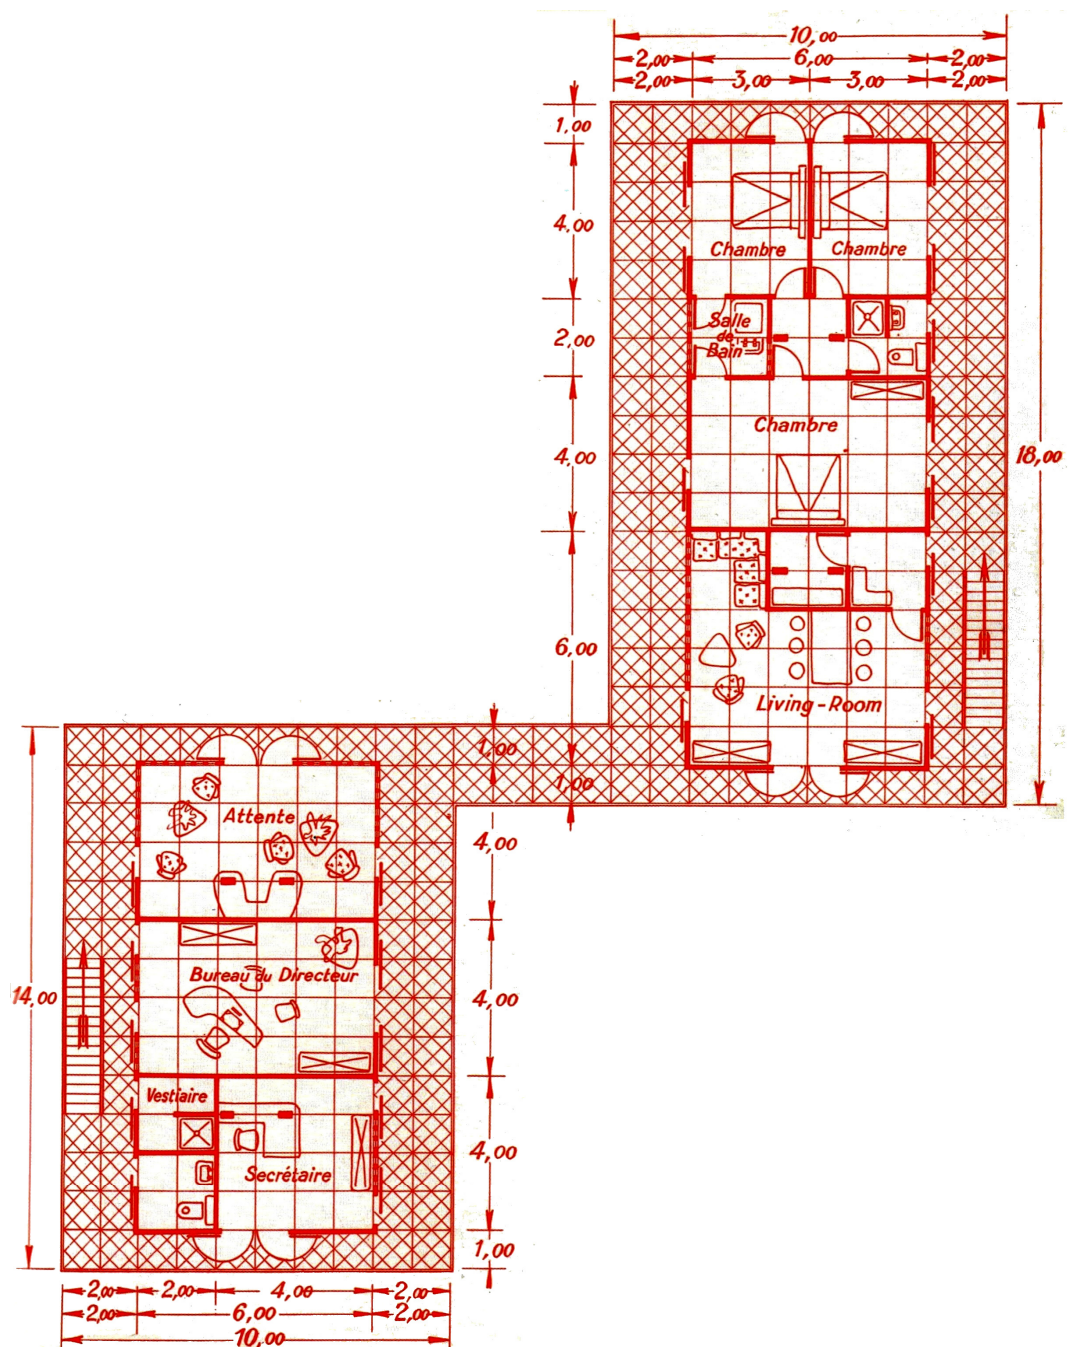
Planta Maison Tropicale em Brazzaville, Congo
